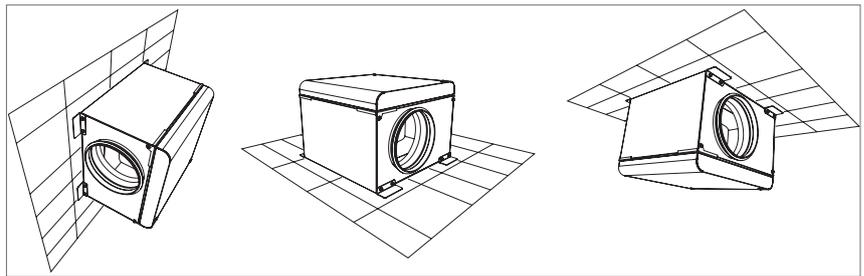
Installation au mur, au sol ou au plafond
